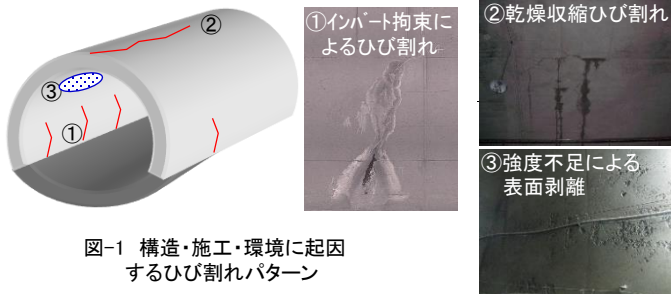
構造・施工・環境に起因するひび割れパターン
